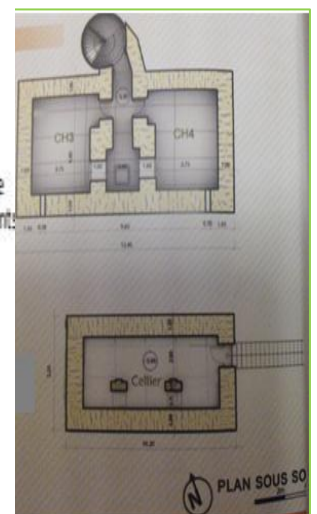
Plan du sous-sol. Source : revue vies de ville N°22
